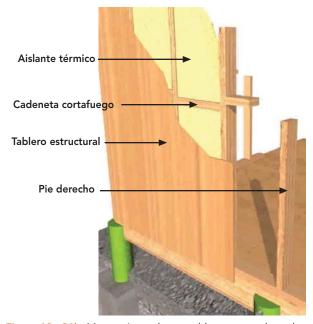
26b: Muro arriostrado con tableros contrachapados, montado sobre plataforma estructurada en madera.
